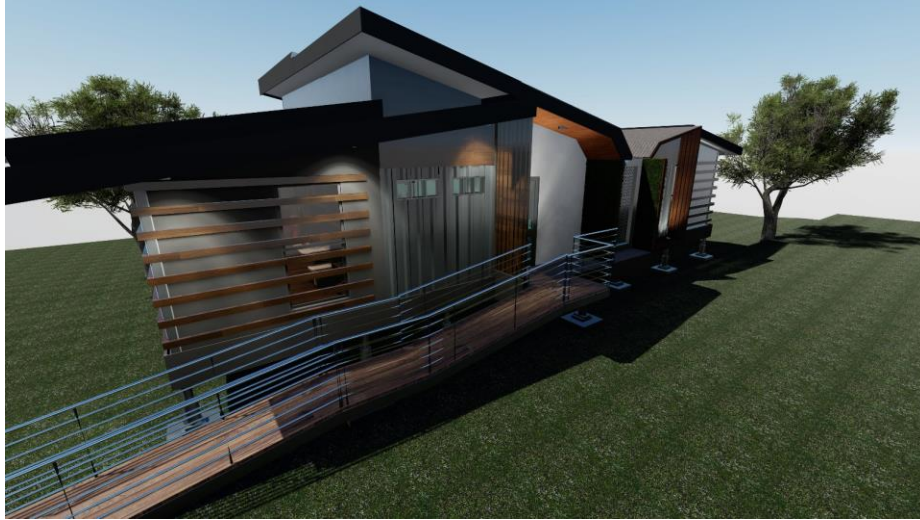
Sistema de Protección Solar. Elaboración Propia. Imagen tomada de documento de renderización.
